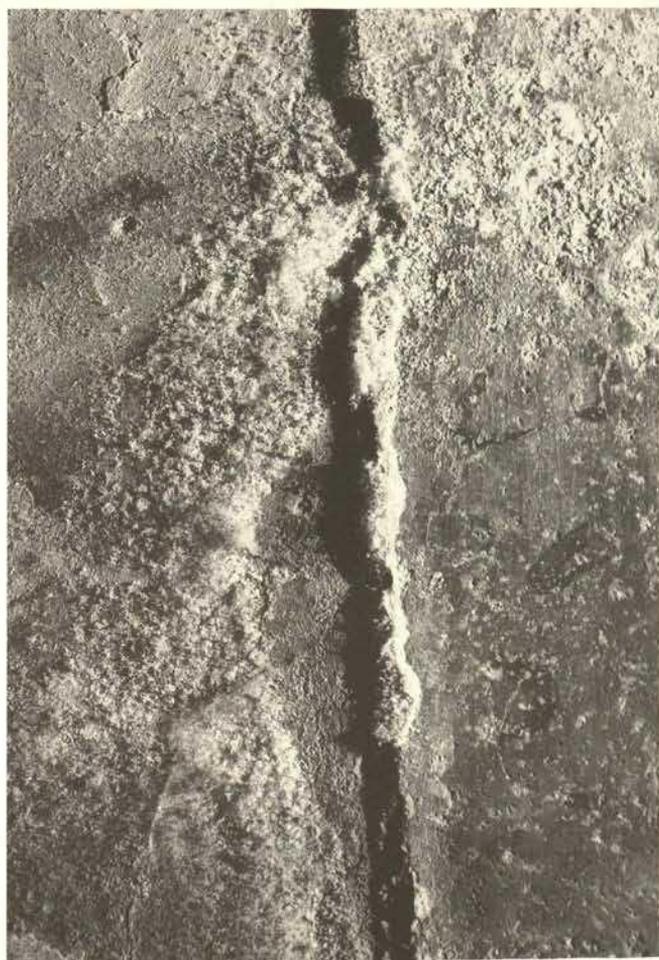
Münstair, Klosterkirche St. Johann, Mittelapsis, Sockel, Oberflächendetail mit durch Salzsprengung bedingten Malschichtschäden (Zustand 1980).
